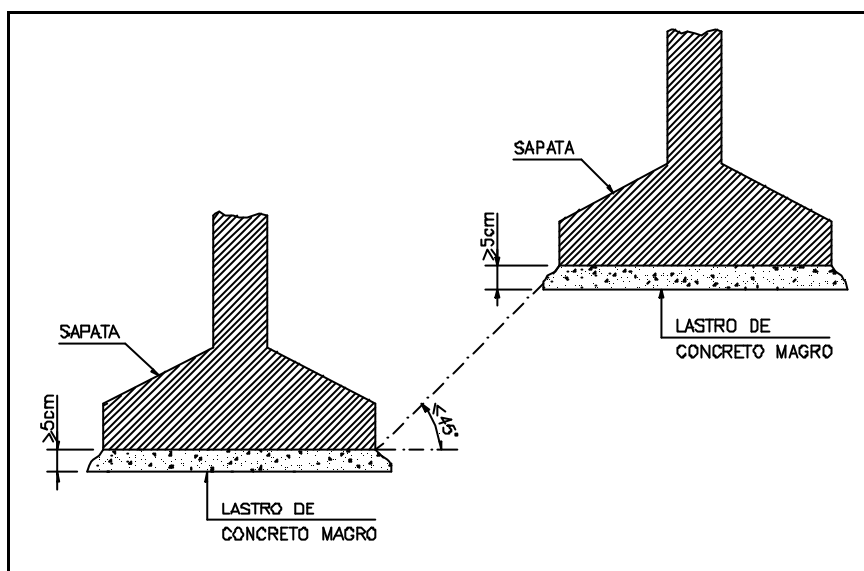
Limite de declividade entre Sapatas ou Blocos escalonadas
